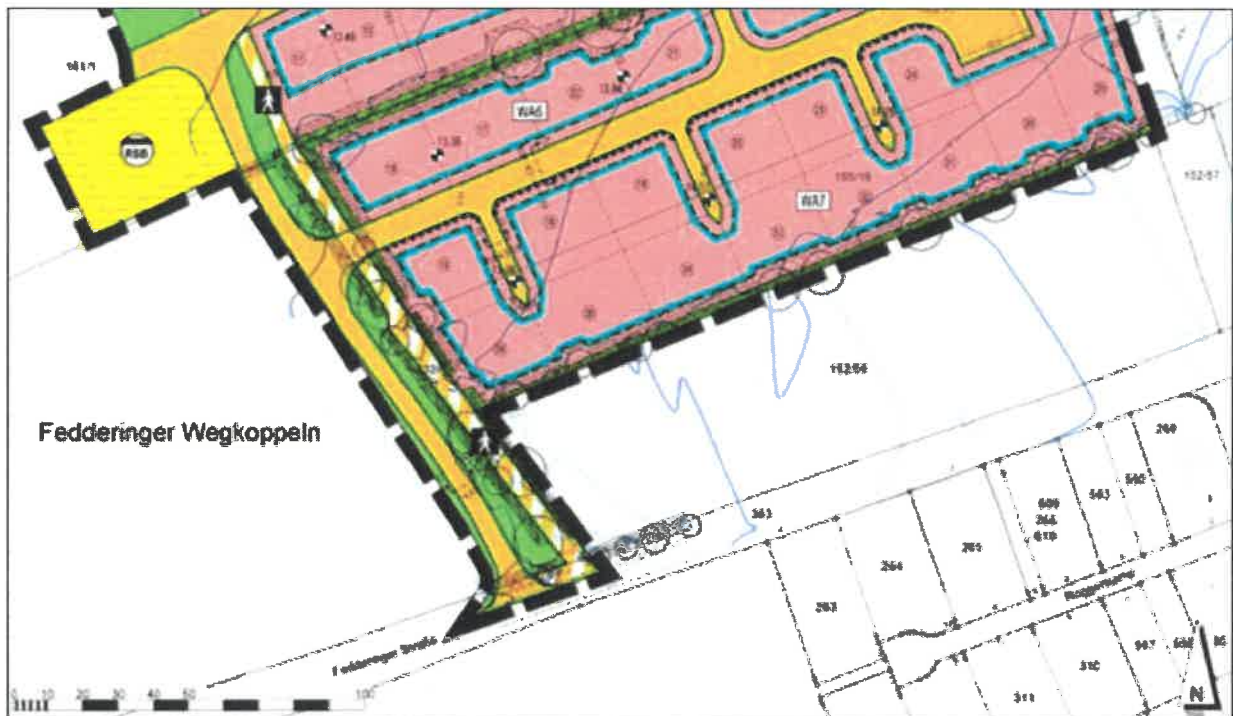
Knotenpunkt Fedderinger Straße / Planstraße
